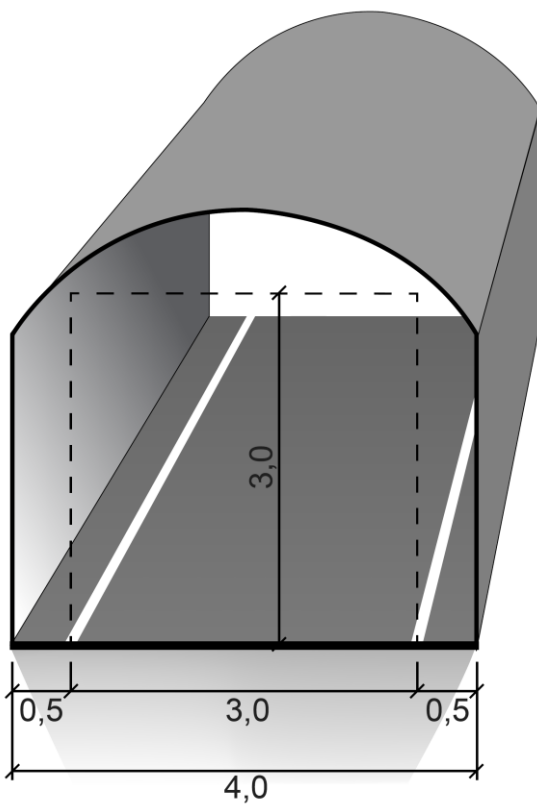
Tunnelprofil T8,5 med møteplass med bredde 3 m (mål i m)
